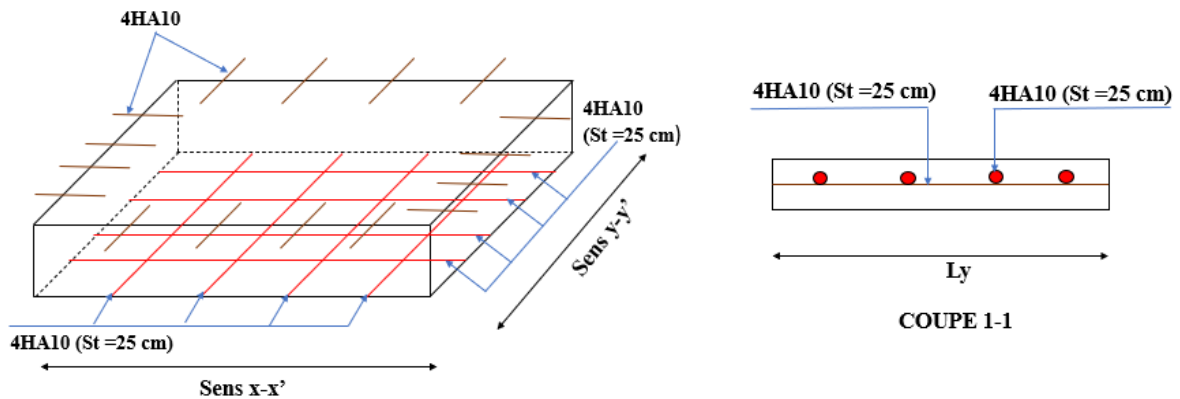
Schéma ferrailage de la dalle pleine au-dessus de l'ascenseur.
